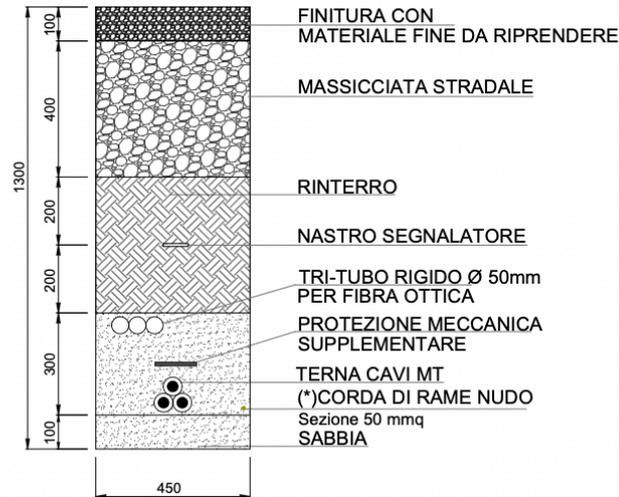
Sezione A-A: posa 1 terna su strada esistente da adeguare
